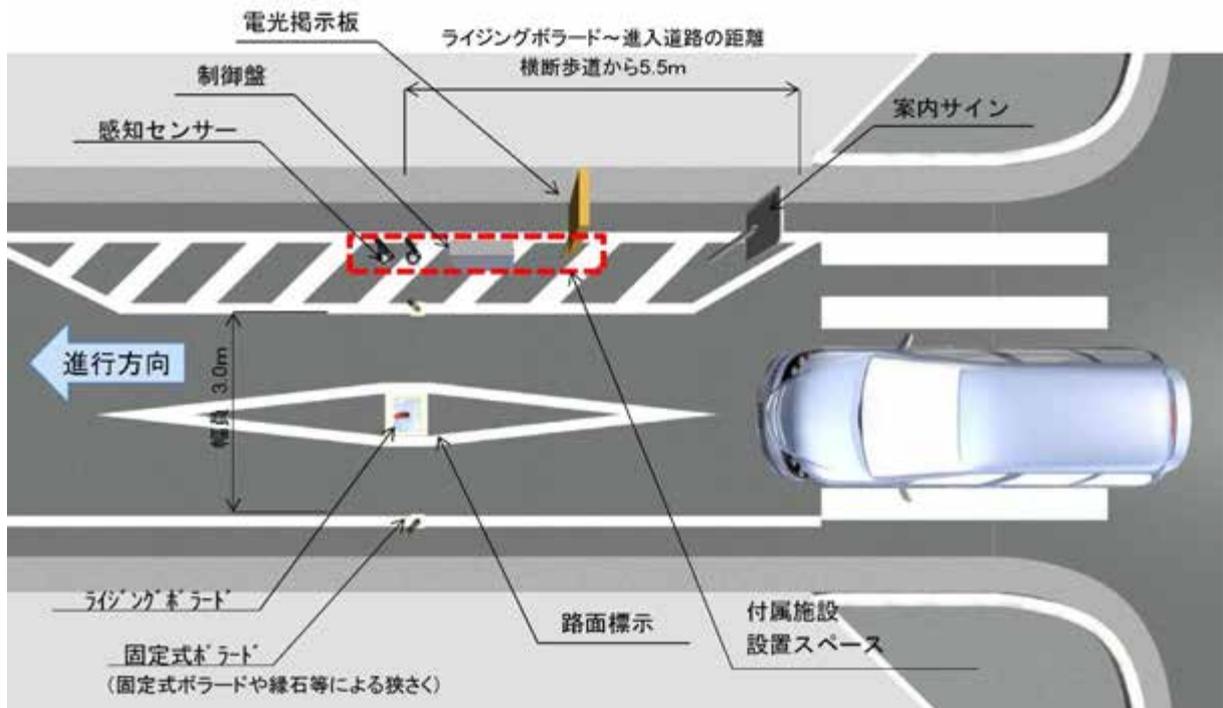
基本形配置平面図（一方通行で歩道なしの道路）
